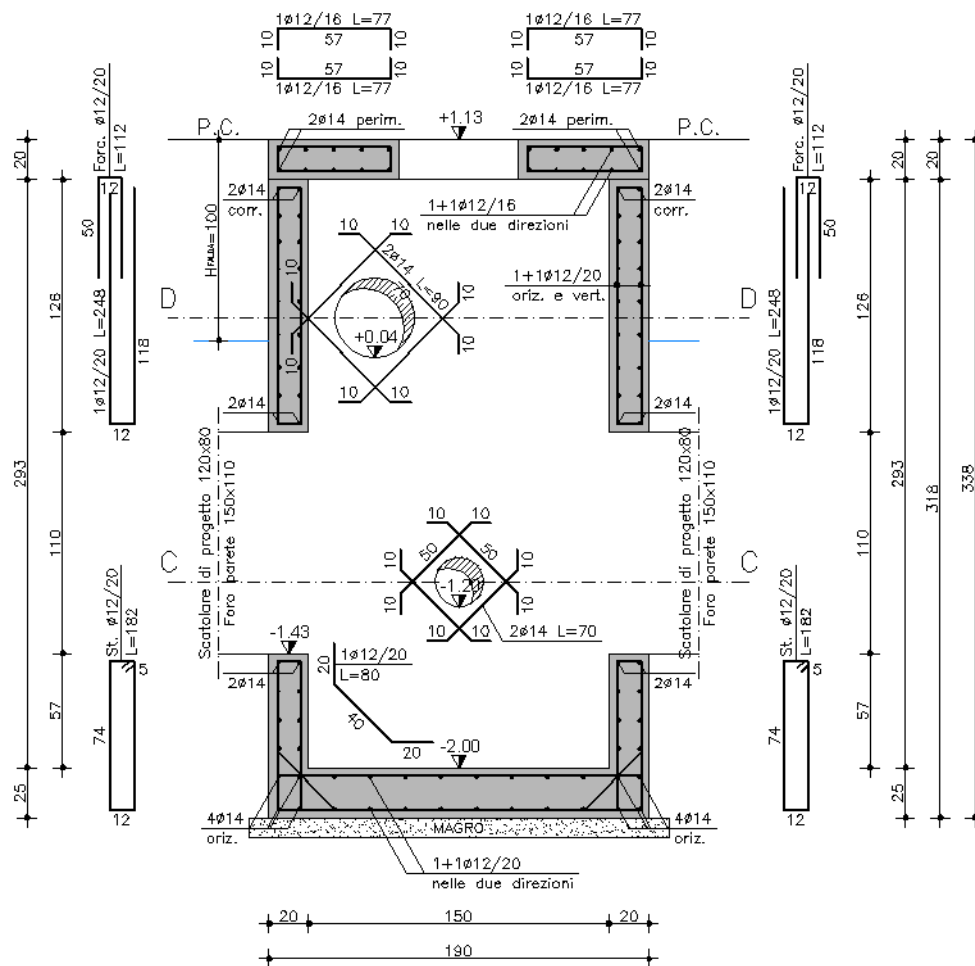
Pozzetto n. 7 - Sezione verticale A-A
